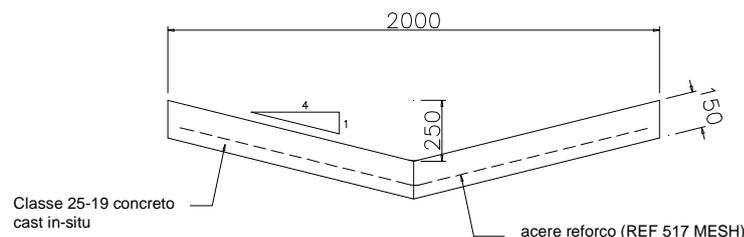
Vala Revestida de Betão Proposta para Secções de Corte
